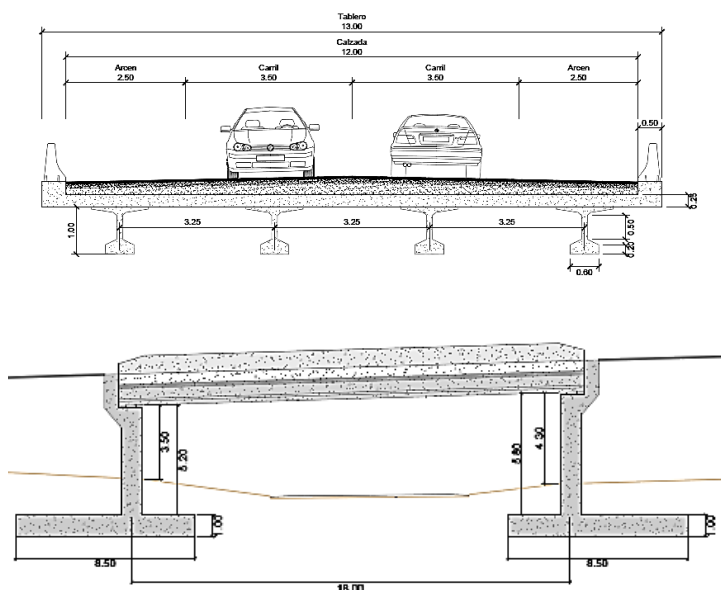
Sección tipo y sección longitudinal del Puente 1
